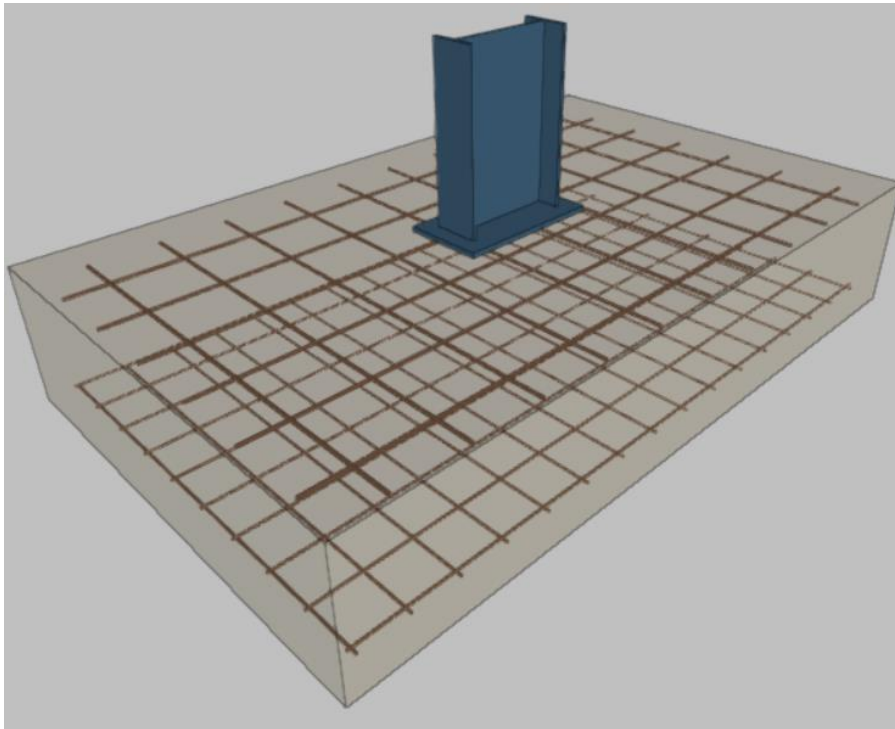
Vista 3D de la zapata correspondiente al pilar esquina IPE 500
